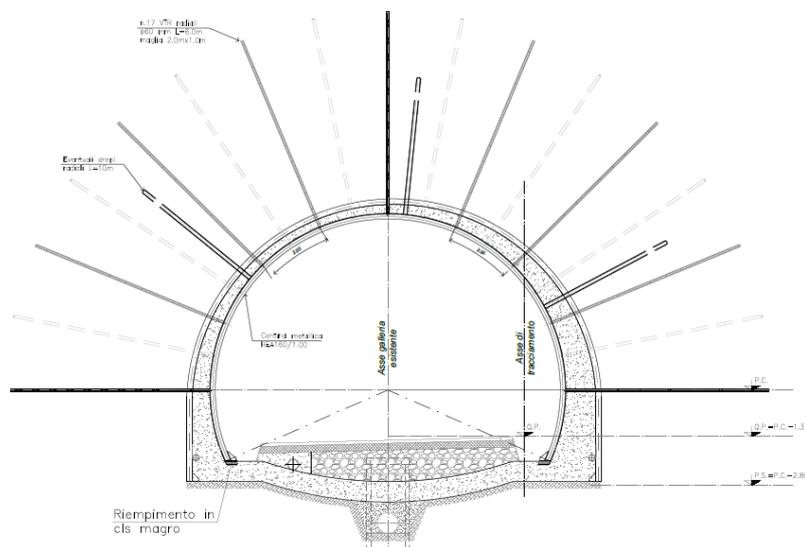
Galleria Guinza – Intervento Tipo A – Sezione corrente – Scavo – Sez. 1
